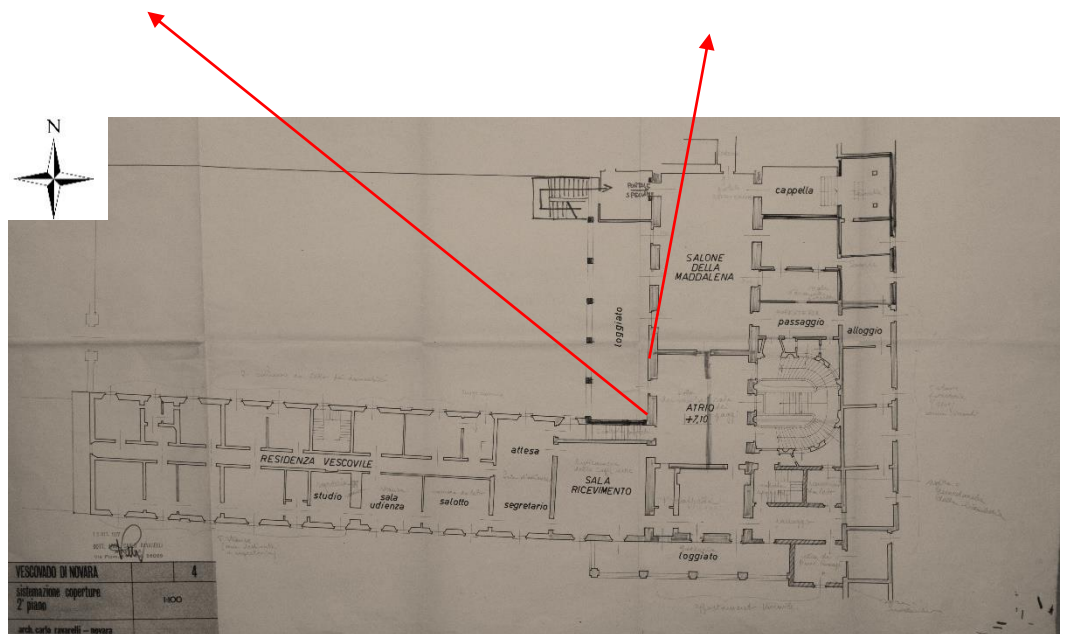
Evidenze del primo piano della fase di tardo XII secolo del Palazzo episcopale (foto E. Casarotti, planimetria dell'Arch. Carlo Ravarelli. Archivio Storico Diocesano di Novara, Disegni, Cassetto 1)
